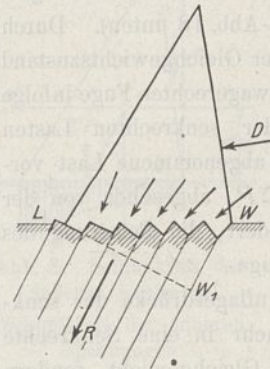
Auflagerflächen der Gründungsfuge senkrecht zur Richtung der Lasten.
